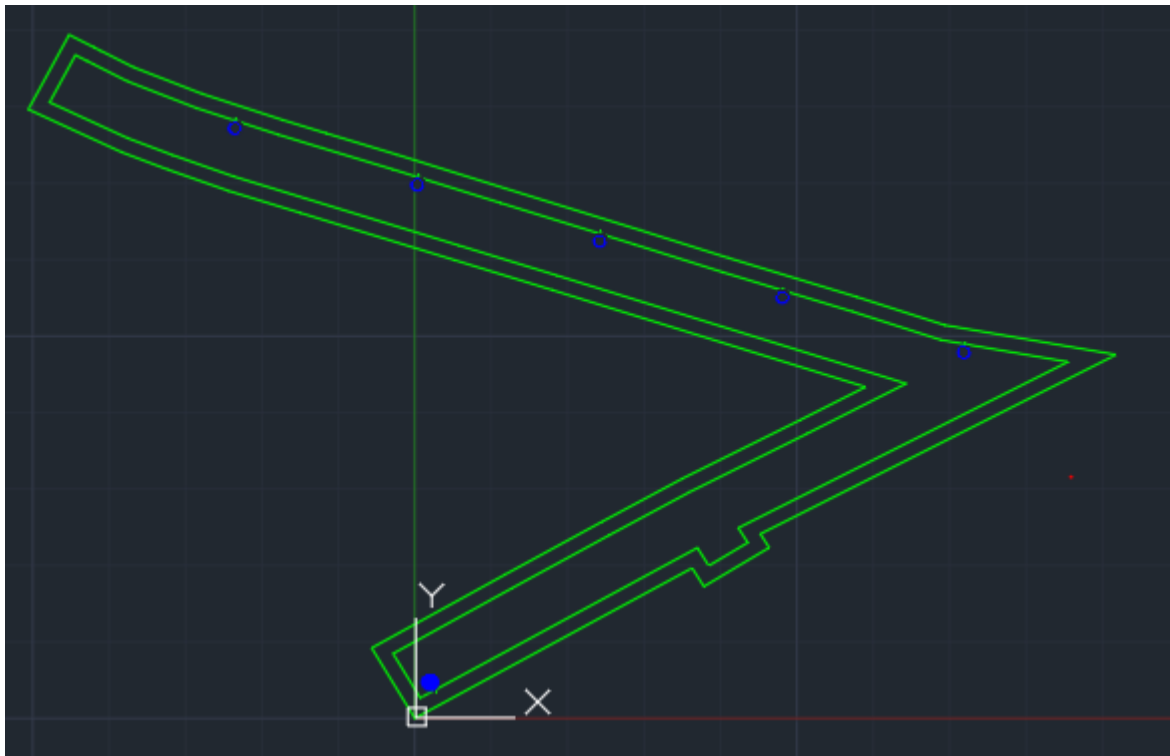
Plano base para andén con los datos del levantamiento (vista en planta).
